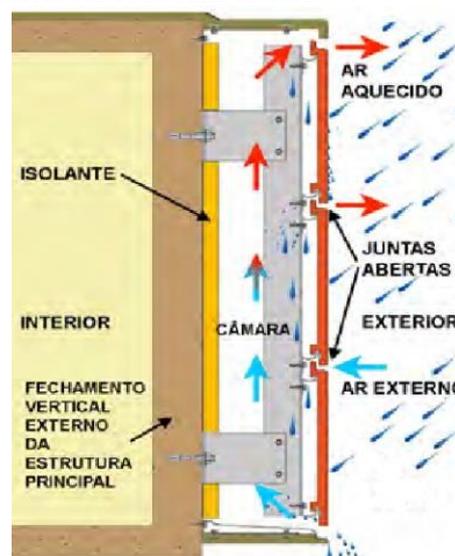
Corte esquemático do sistema de fachada ventilada. Fonte: [7], adaptado pelo autor.
